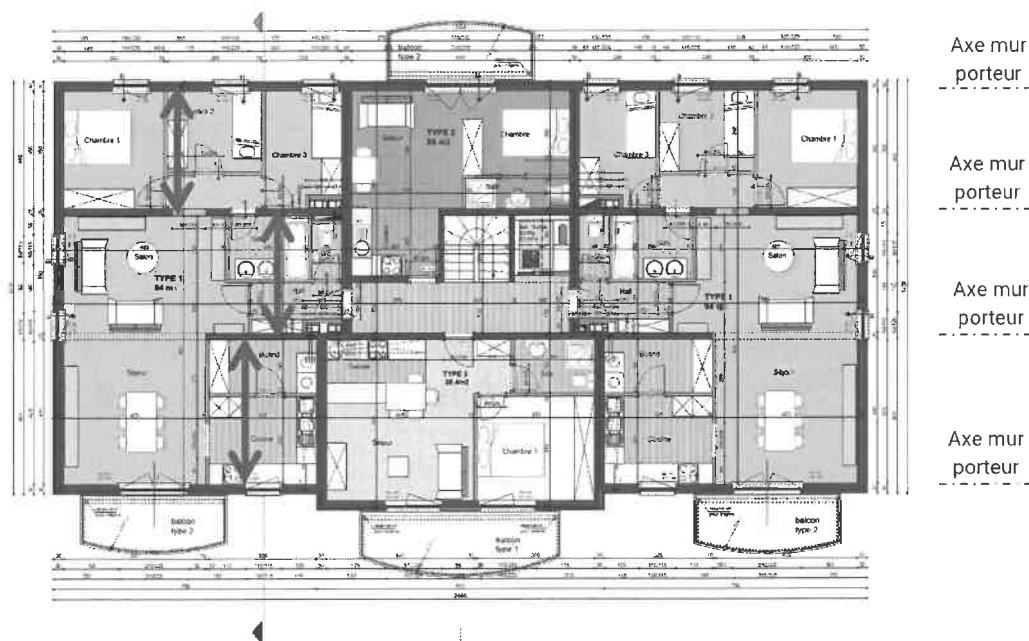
Niveau type – Axes murs porteurs et sens de portée présumé des planchers
